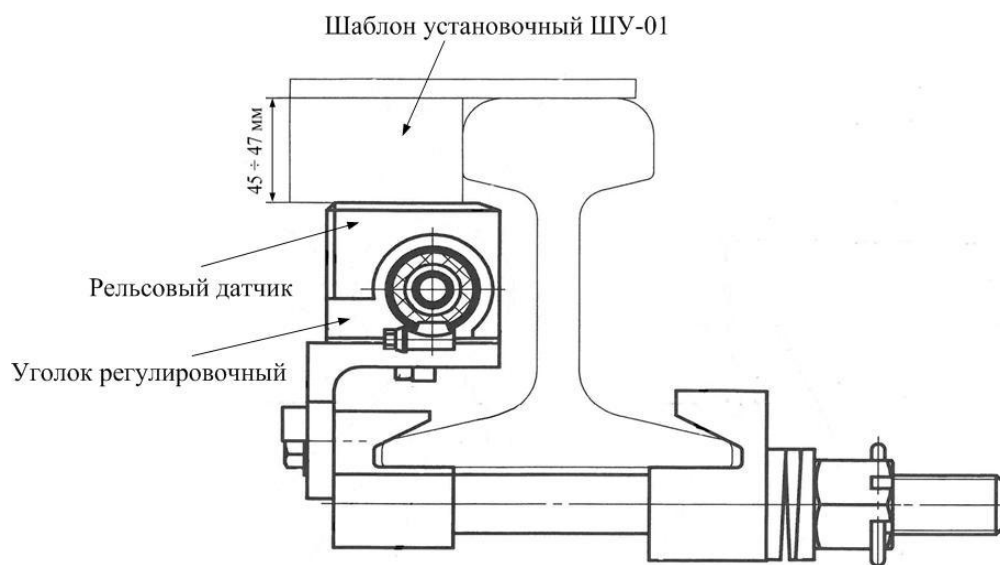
Наложение шаблона установочного ШУ-01 для проверки правильности крепления датчика ДПВ-02У к рельсу.
